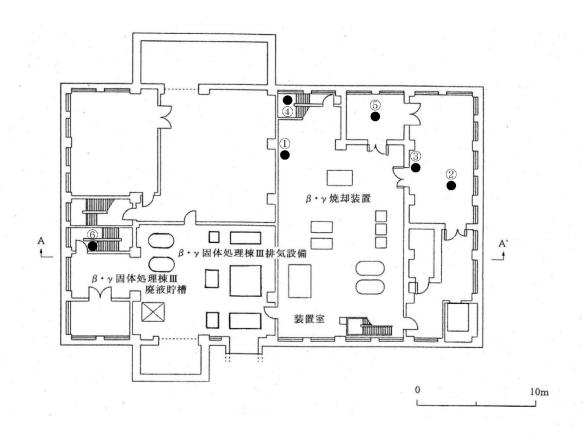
β・γ固体処理棟 I 平面図及び可燃物配置図
